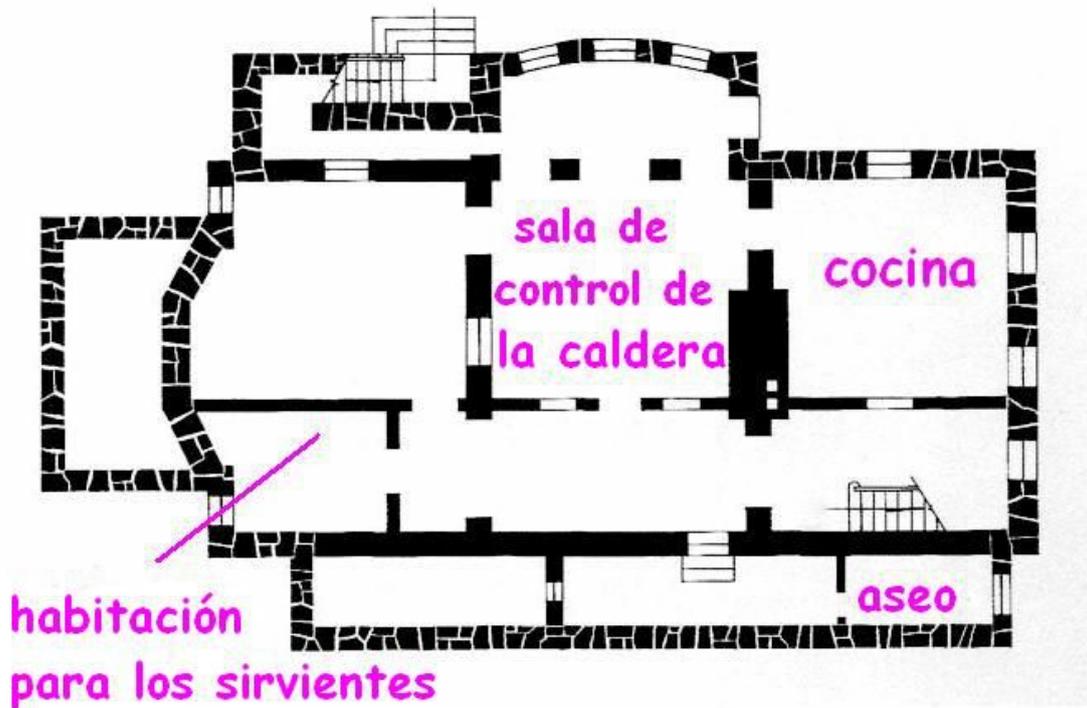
Planta subterránea de la “Casa de Tse-ven Soong”
